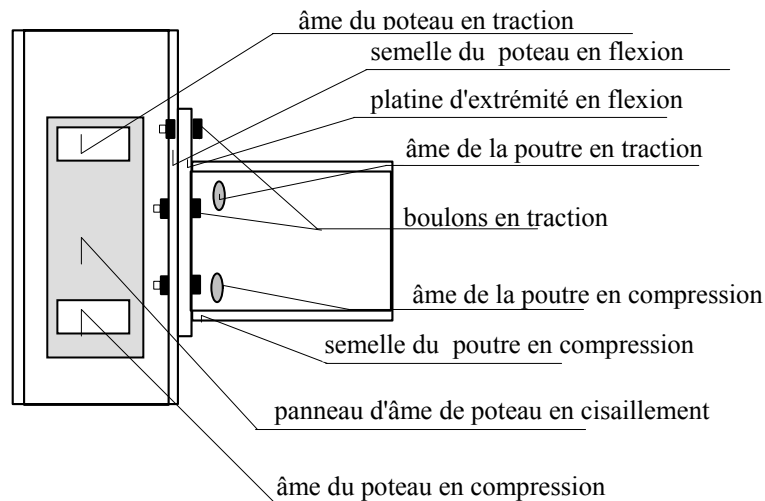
Composantes de base de l'assemblage par platine d'about boulonnée
